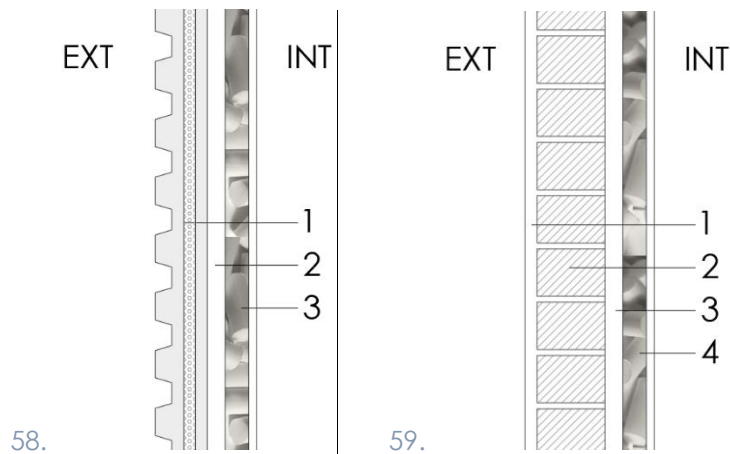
y 59. Detalles de envolvente Tipo 1 y Tipo 2 (secciones verticales) con aislamiento de filtros en Málaga. Fuente: Elaboración propia
